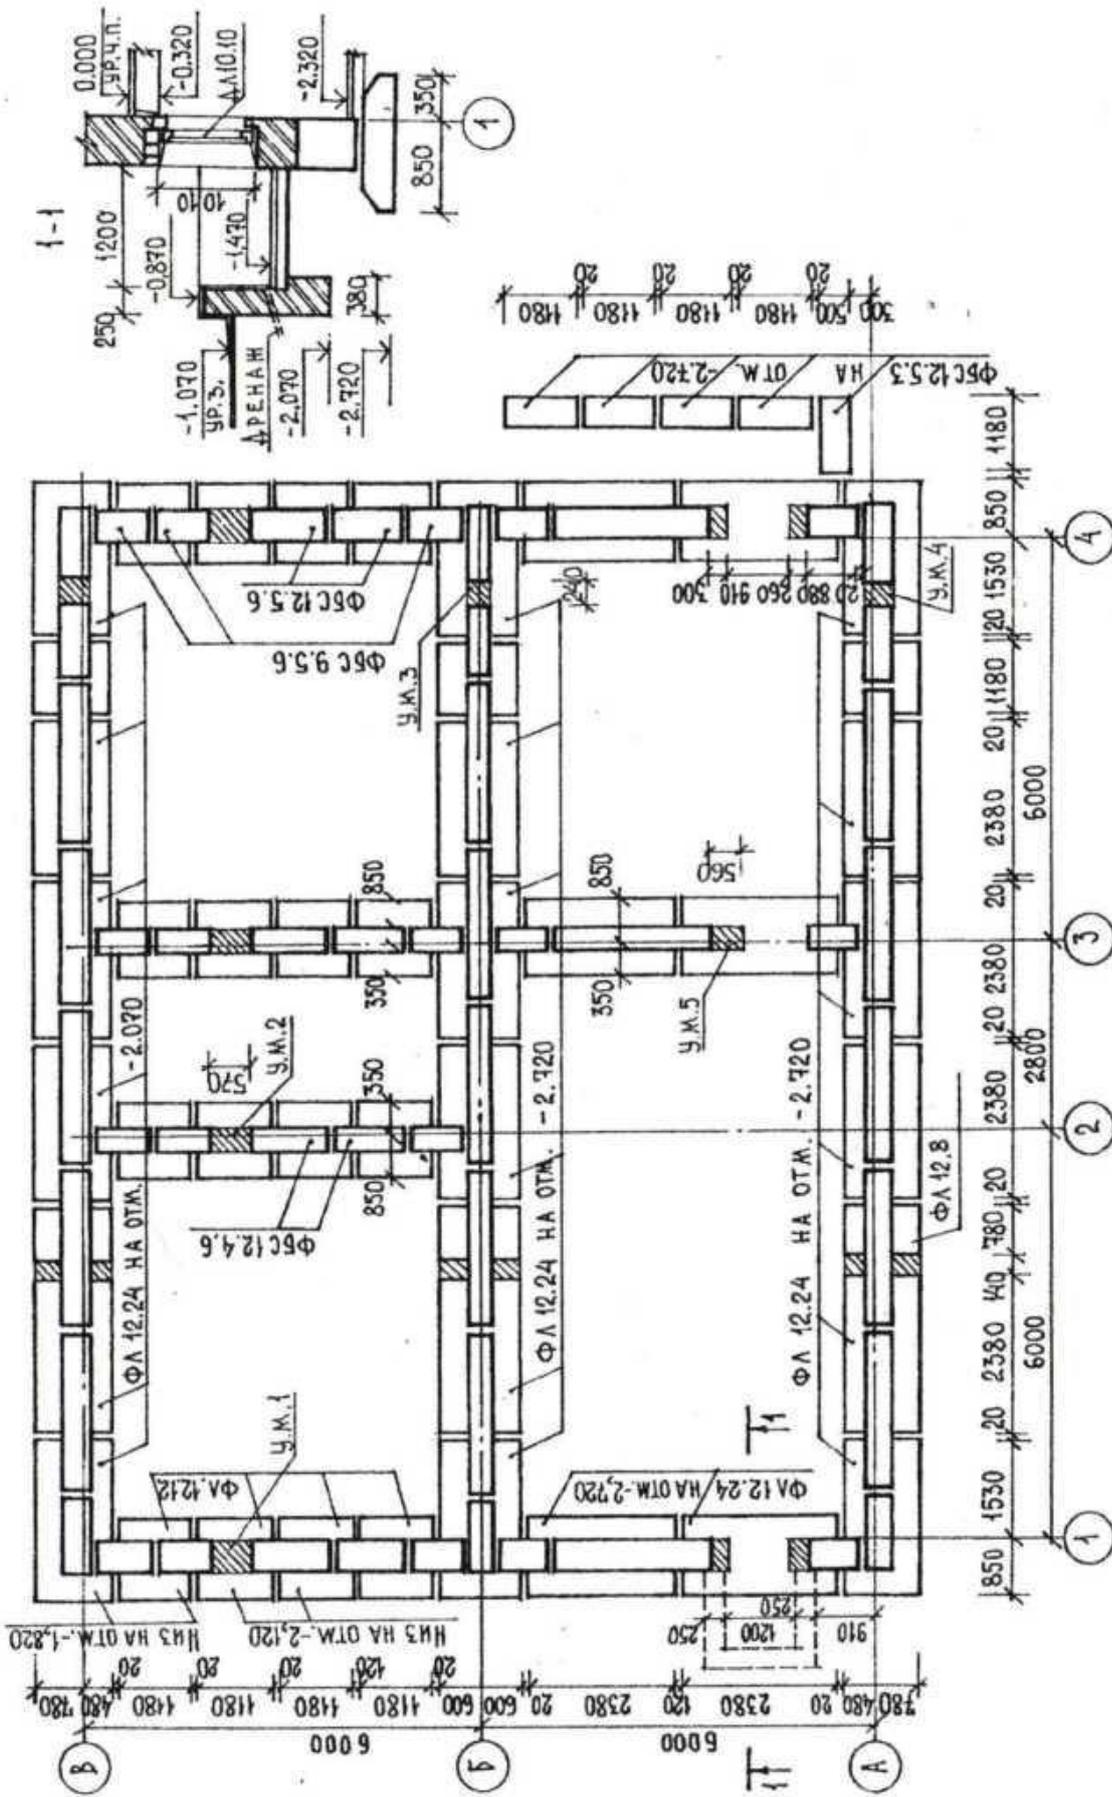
Схема расположения ленточного фундамента из сборных железобетонных блоков
